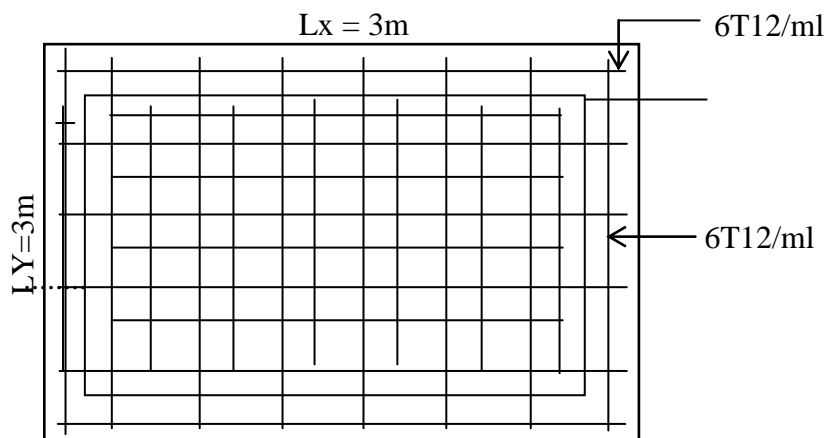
Schéma Ferrailage inférieur du panneau de la dalle pleine.
